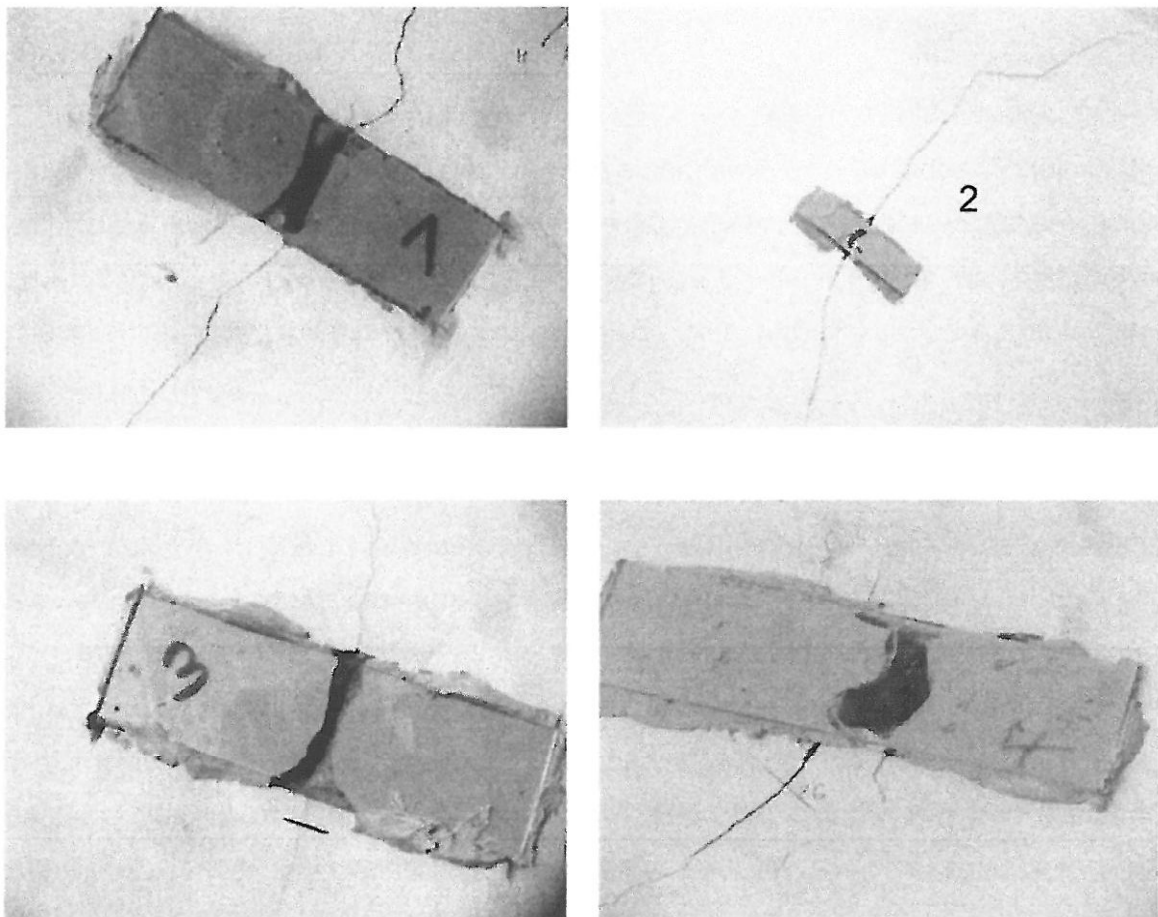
Przykładowe zarysowania tynków sufitowych przy fasetach (26.08.2021)
